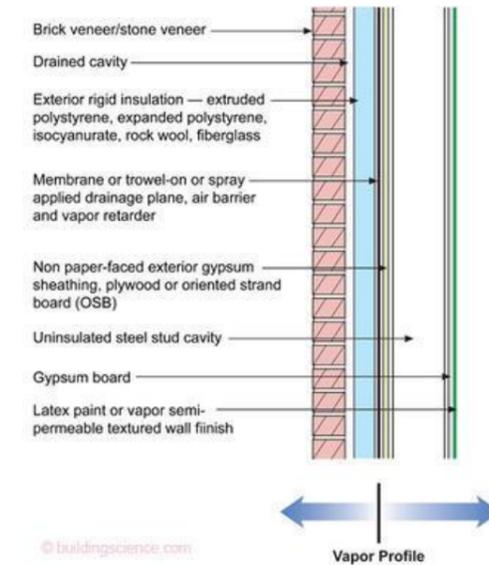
Muro comercial tipo II. Fuente: Building science. Elaboración: Building science. (2020).
